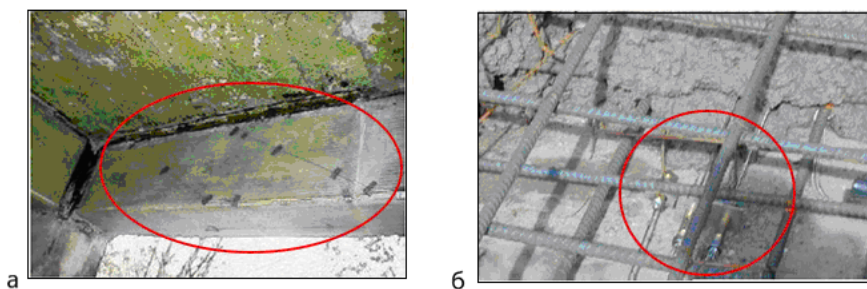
Волоконные датчики деформации поверхностного монтажа на балке (а) моста и датчик (б) в бетонной плите до заливки железобетона
